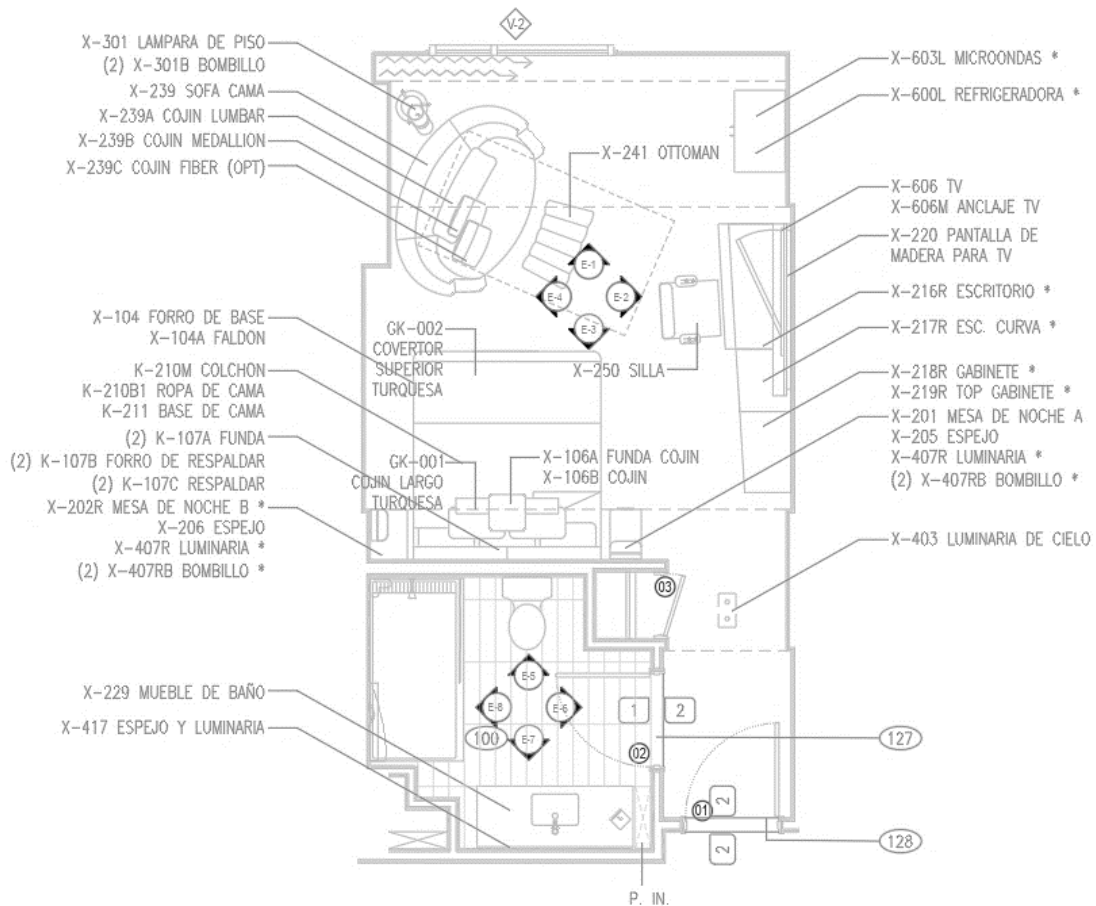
Planta de Muebles Habitación Tipo King Hotel Courtyard
